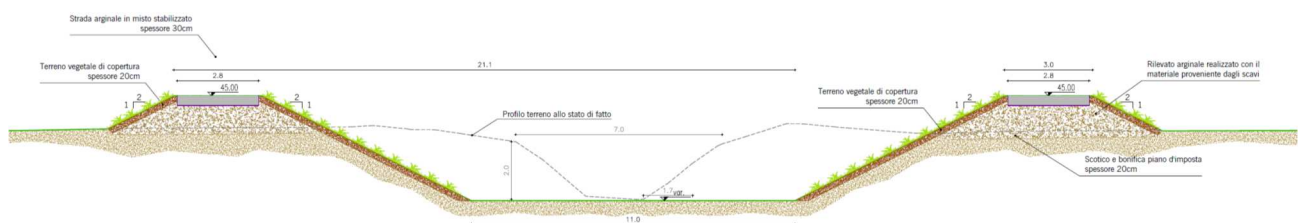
Sezione tipo dell'intervento di risezionamento fluviale previsto.
